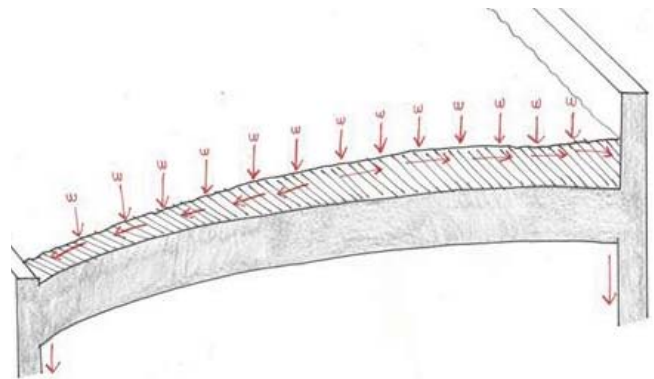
Isométrico de la cubierta indicando las bajadas de cargas hacia los muros perimetrales.
